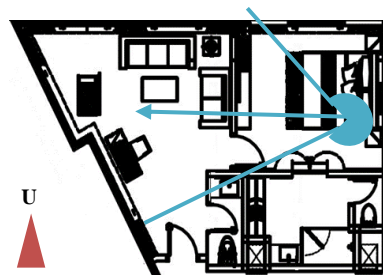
Dimensi Fasade dan Tampilan pada Denah; Rekomendasi 2
